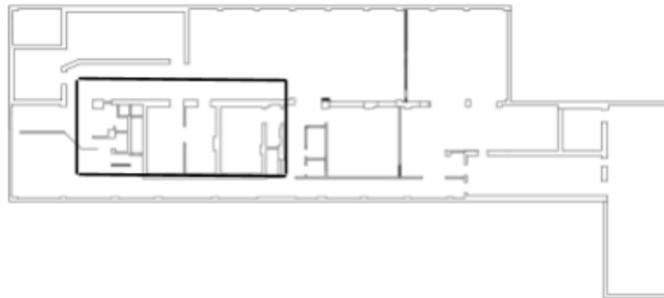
Planta baja - Recuadro de layout a detallar.
